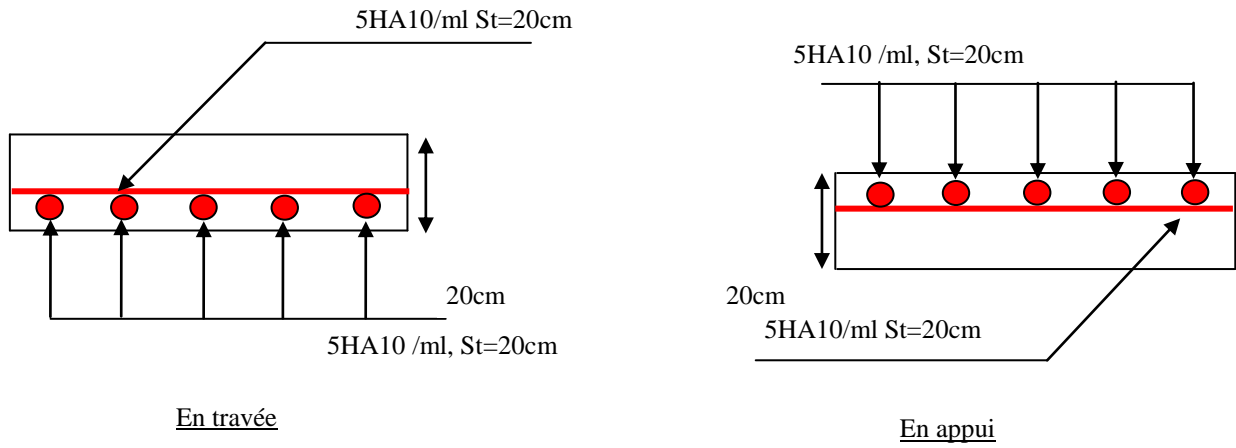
Schéma de ferrailage de la dalle pleine du local machine
